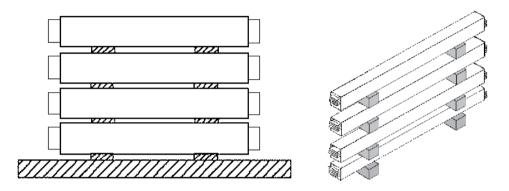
Lagerung von Einfachsystemen hoch- und flachkant
